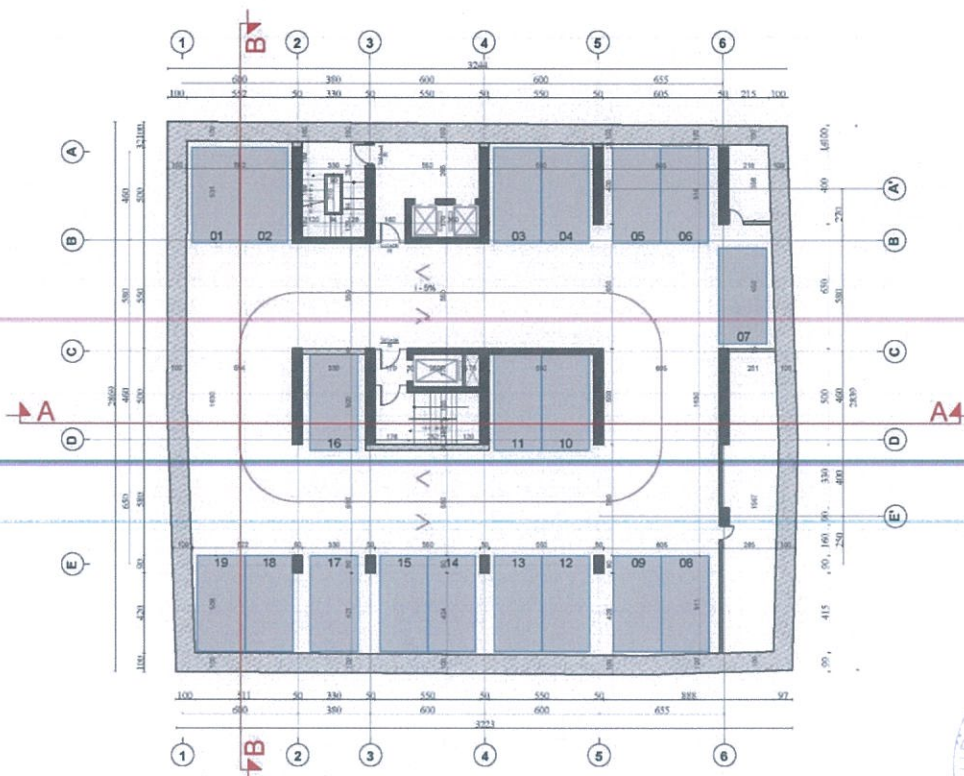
Plani i Parkimit Kati Tip -2, -3, -4, -5, -6
